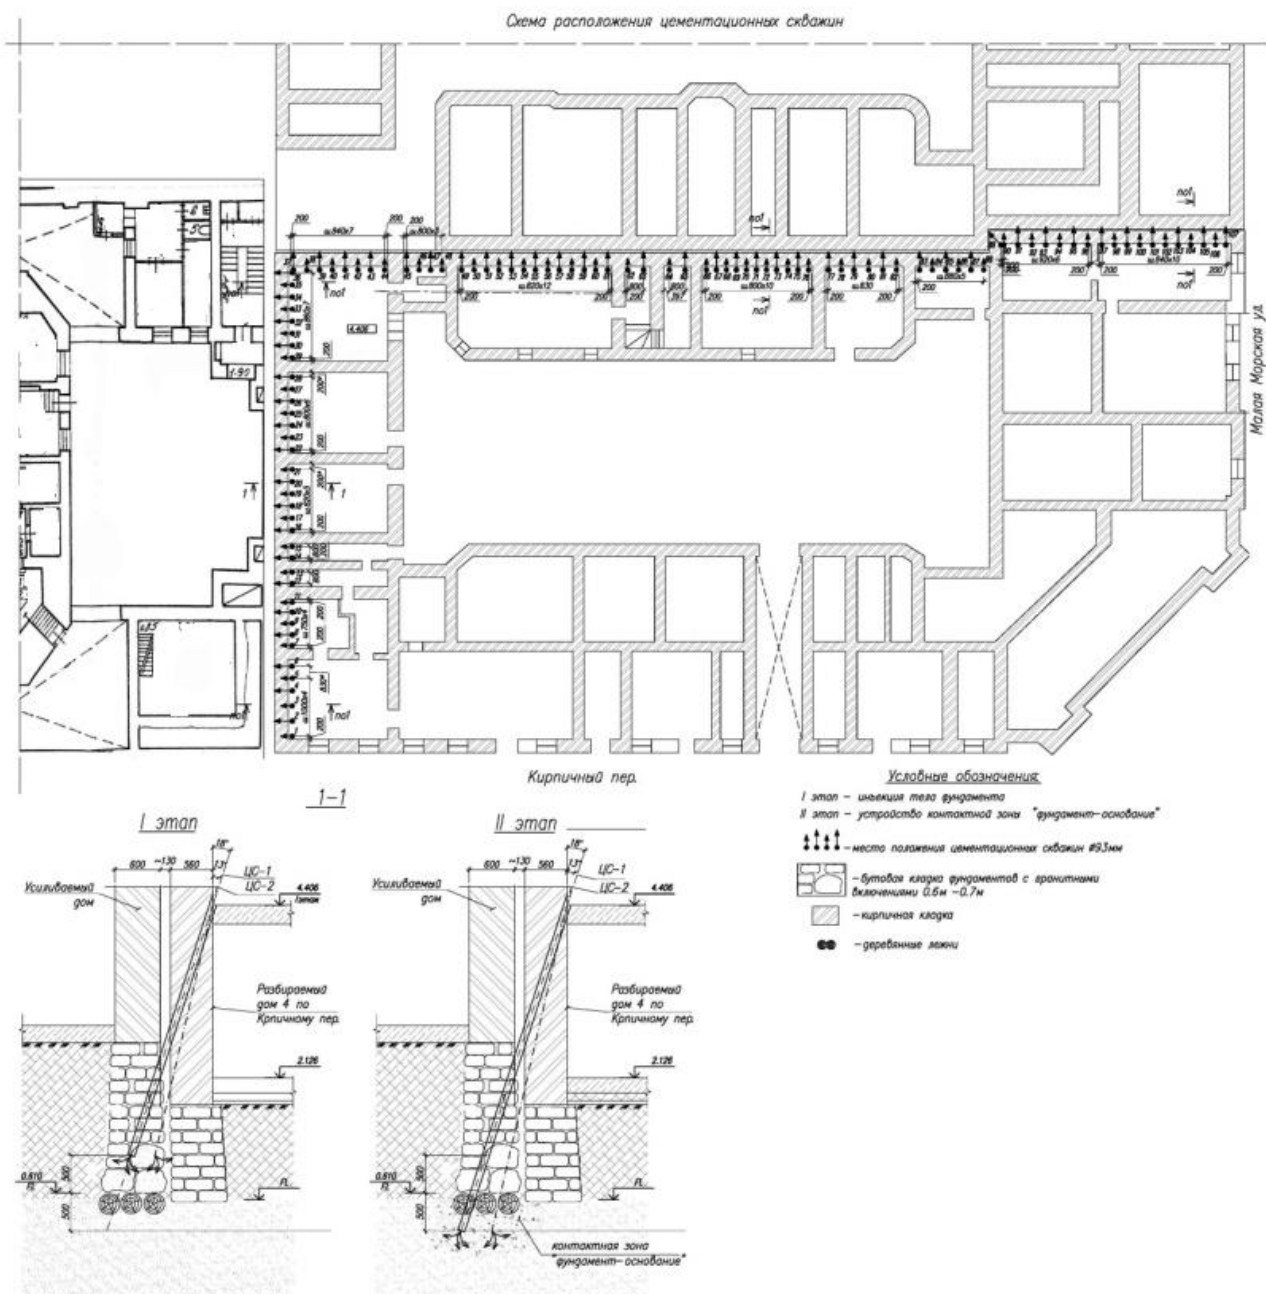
Схема усиления фундаментов здания и грунтов основания соседней застройки с использованием инъекционного укрепления фундаментов и закрепления грунтов
